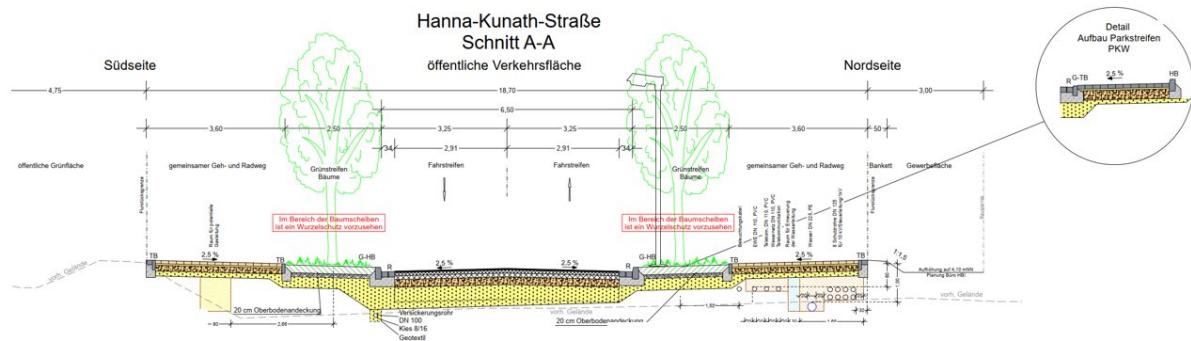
Darstellung des geplanten Straßenquerschnitts
